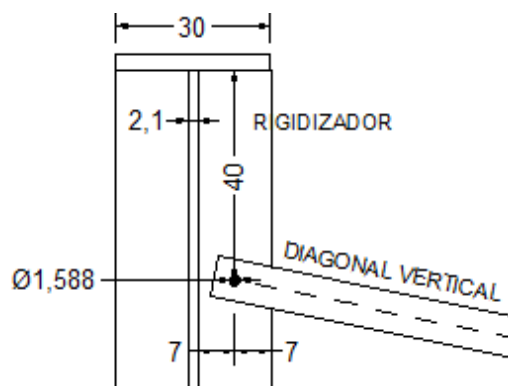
Detalle de conexión apernada rigidizador transversal de apoyo-diagonal vertical
